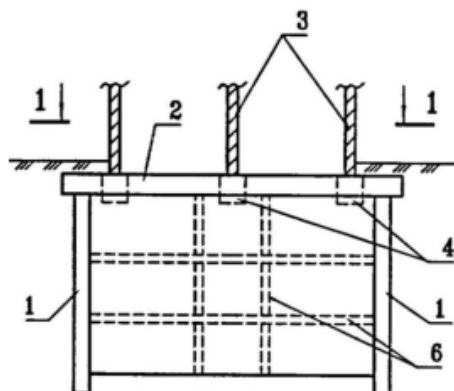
Схема устройства подземного этажа по патенту 2225916: 1 – стены подземного сооружения; 2 – железобетонная несущая плита; 3 – несущие стены здания; 4 – фундаменты; 6 – конструкции подземных этажей
